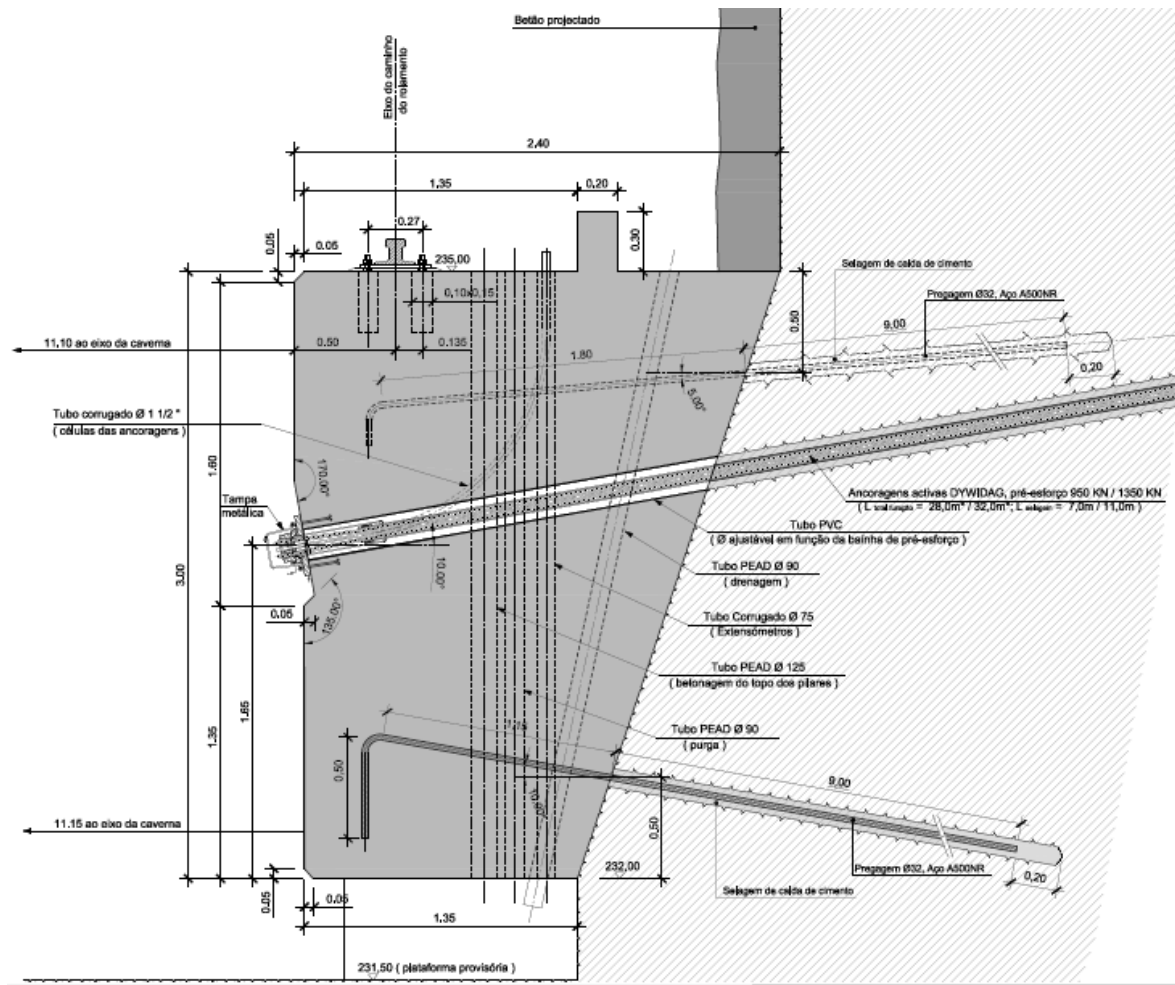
Pormenor de Uma das Vigas de Apoio da Ponte Rolante e Teto Falso da Central VNIII
